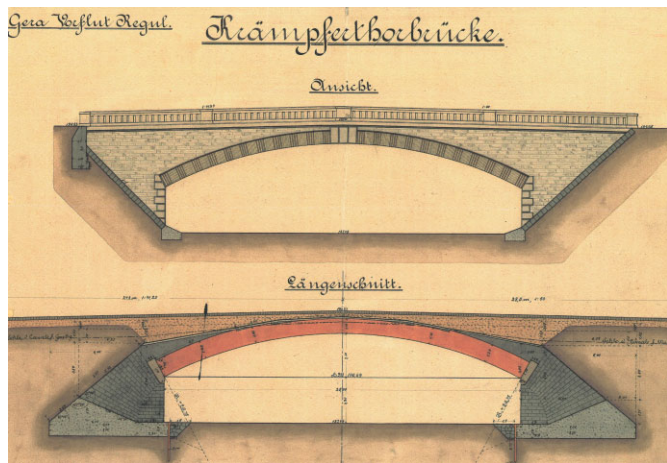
Krämpfertorbrücke – Bauwerksplan – HERMANN KICKTON – 1895
